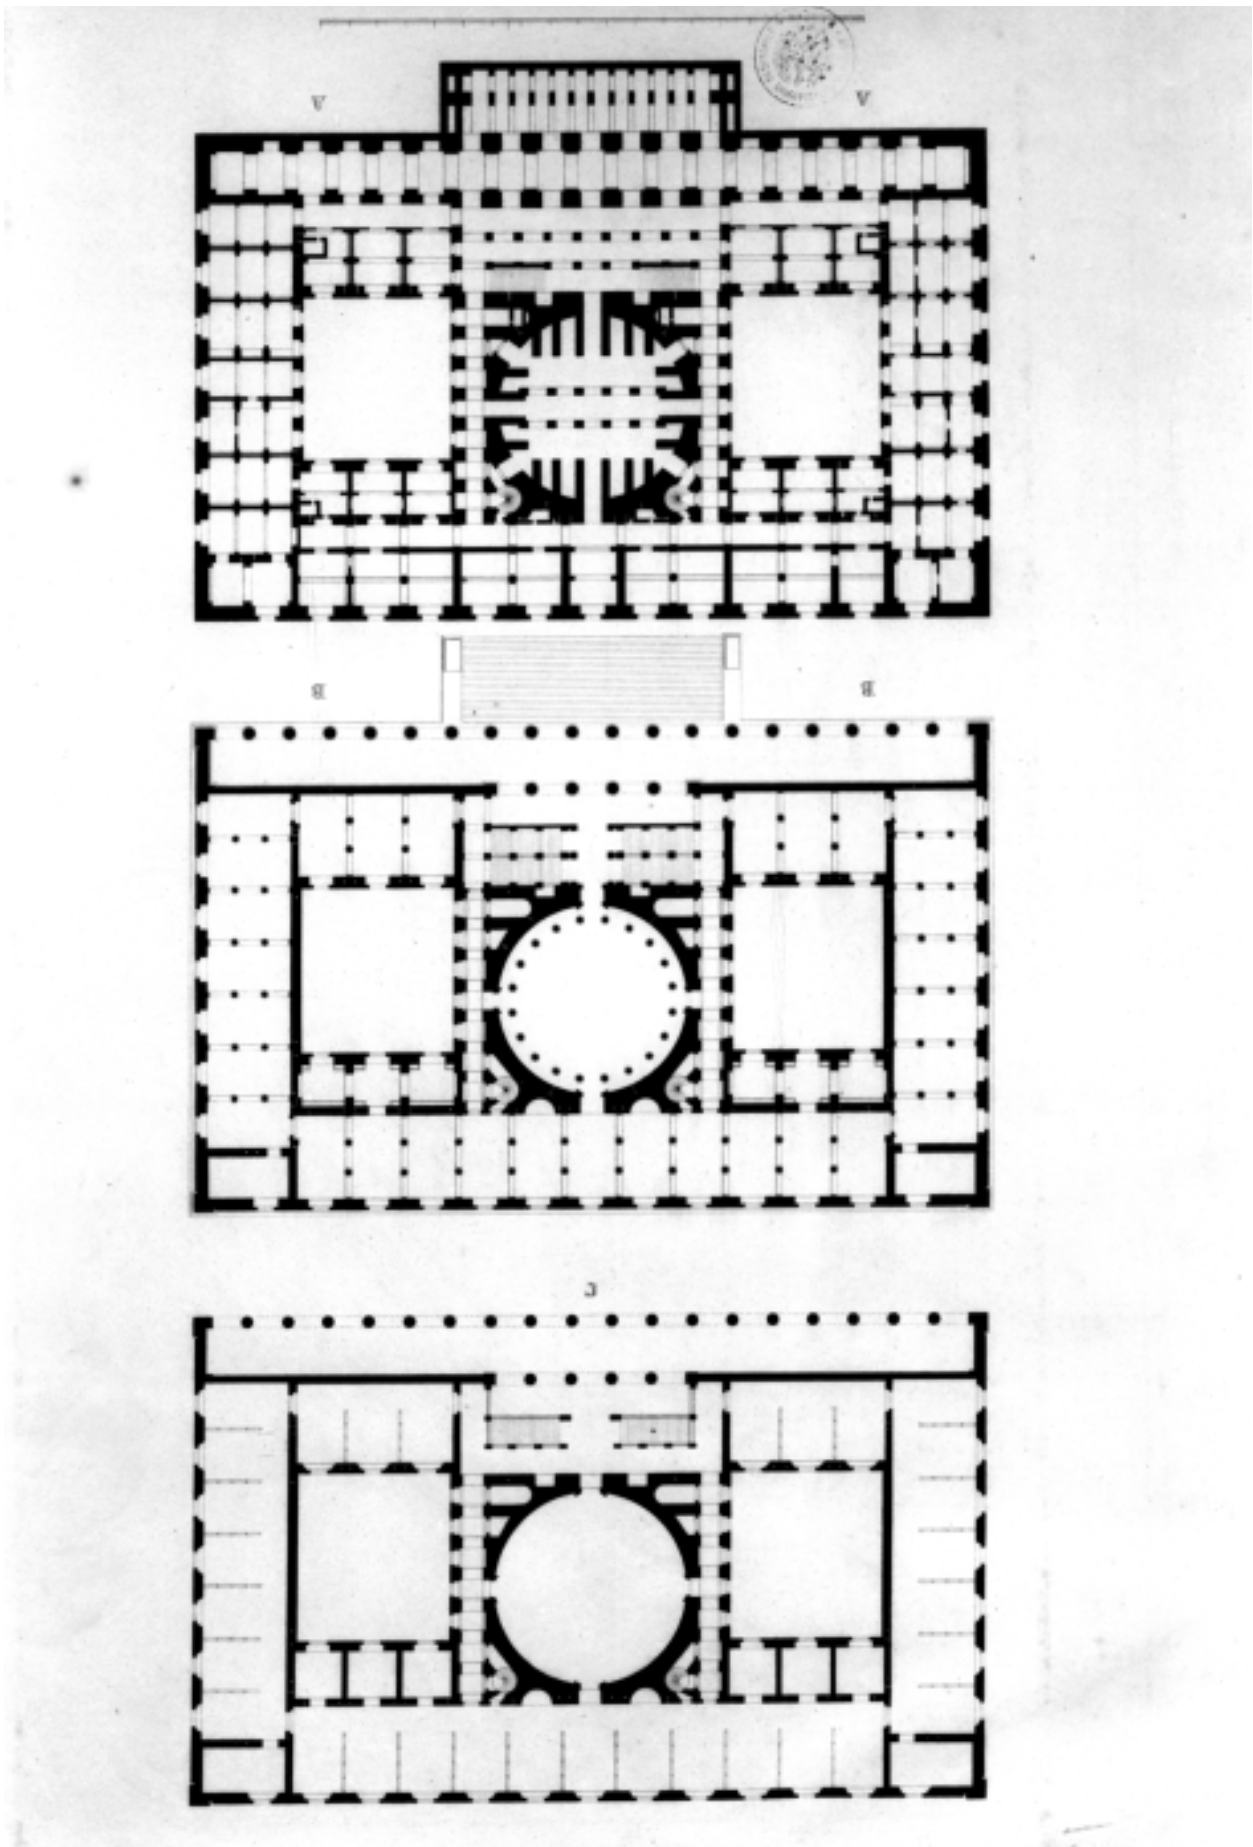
Schinkel 1825. Dem Grundriss des alten Museums in Berlin liegt ein materialsparender und vielseitig nutzbarer Rastergrundriss zu Grunde.
